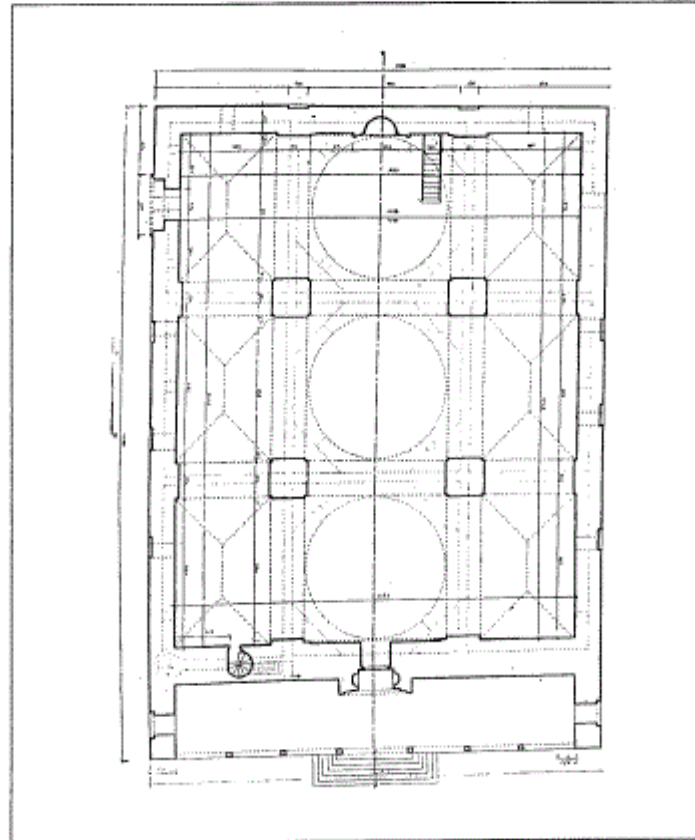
مسقط أفقي وقطاع لمسجد غازي خسرو بك في سرايفو (عن: Pašić).
